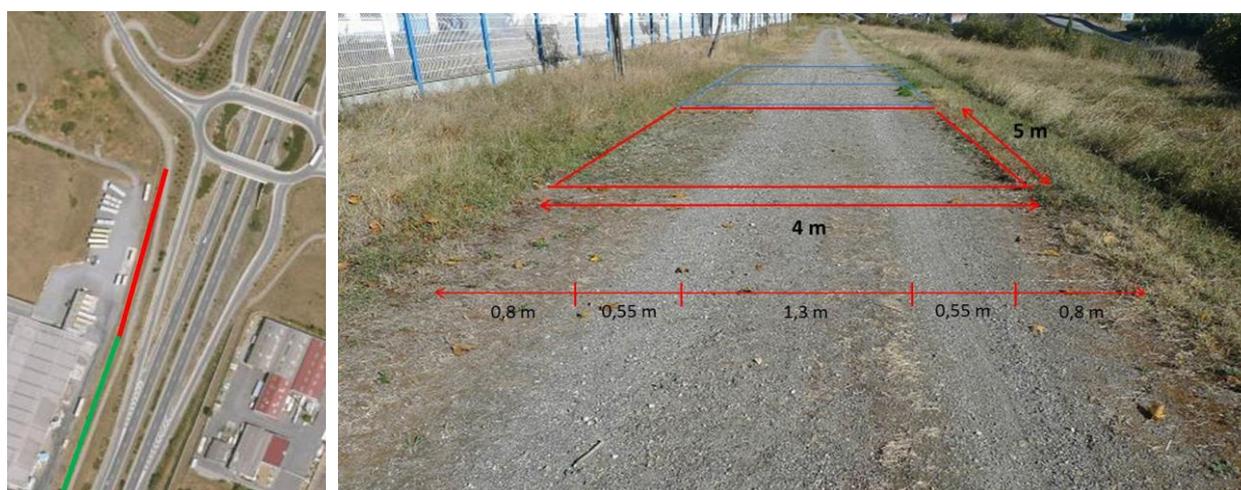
Plan de l'essai P2SP. A gauche ; vue aérienne de la zone d'essai avec disposition des blocs. A droite ; profil d'une parcelle de l'essai P2SP.
